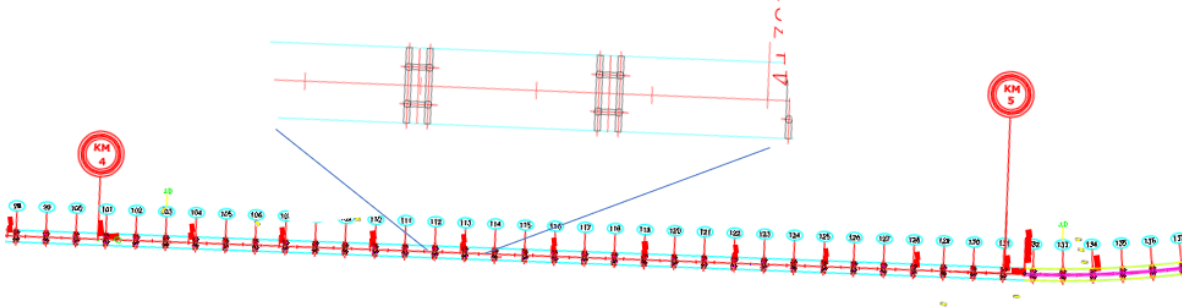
Procedimiento para el hincado del ademe metálico de las pilas de cimentación
